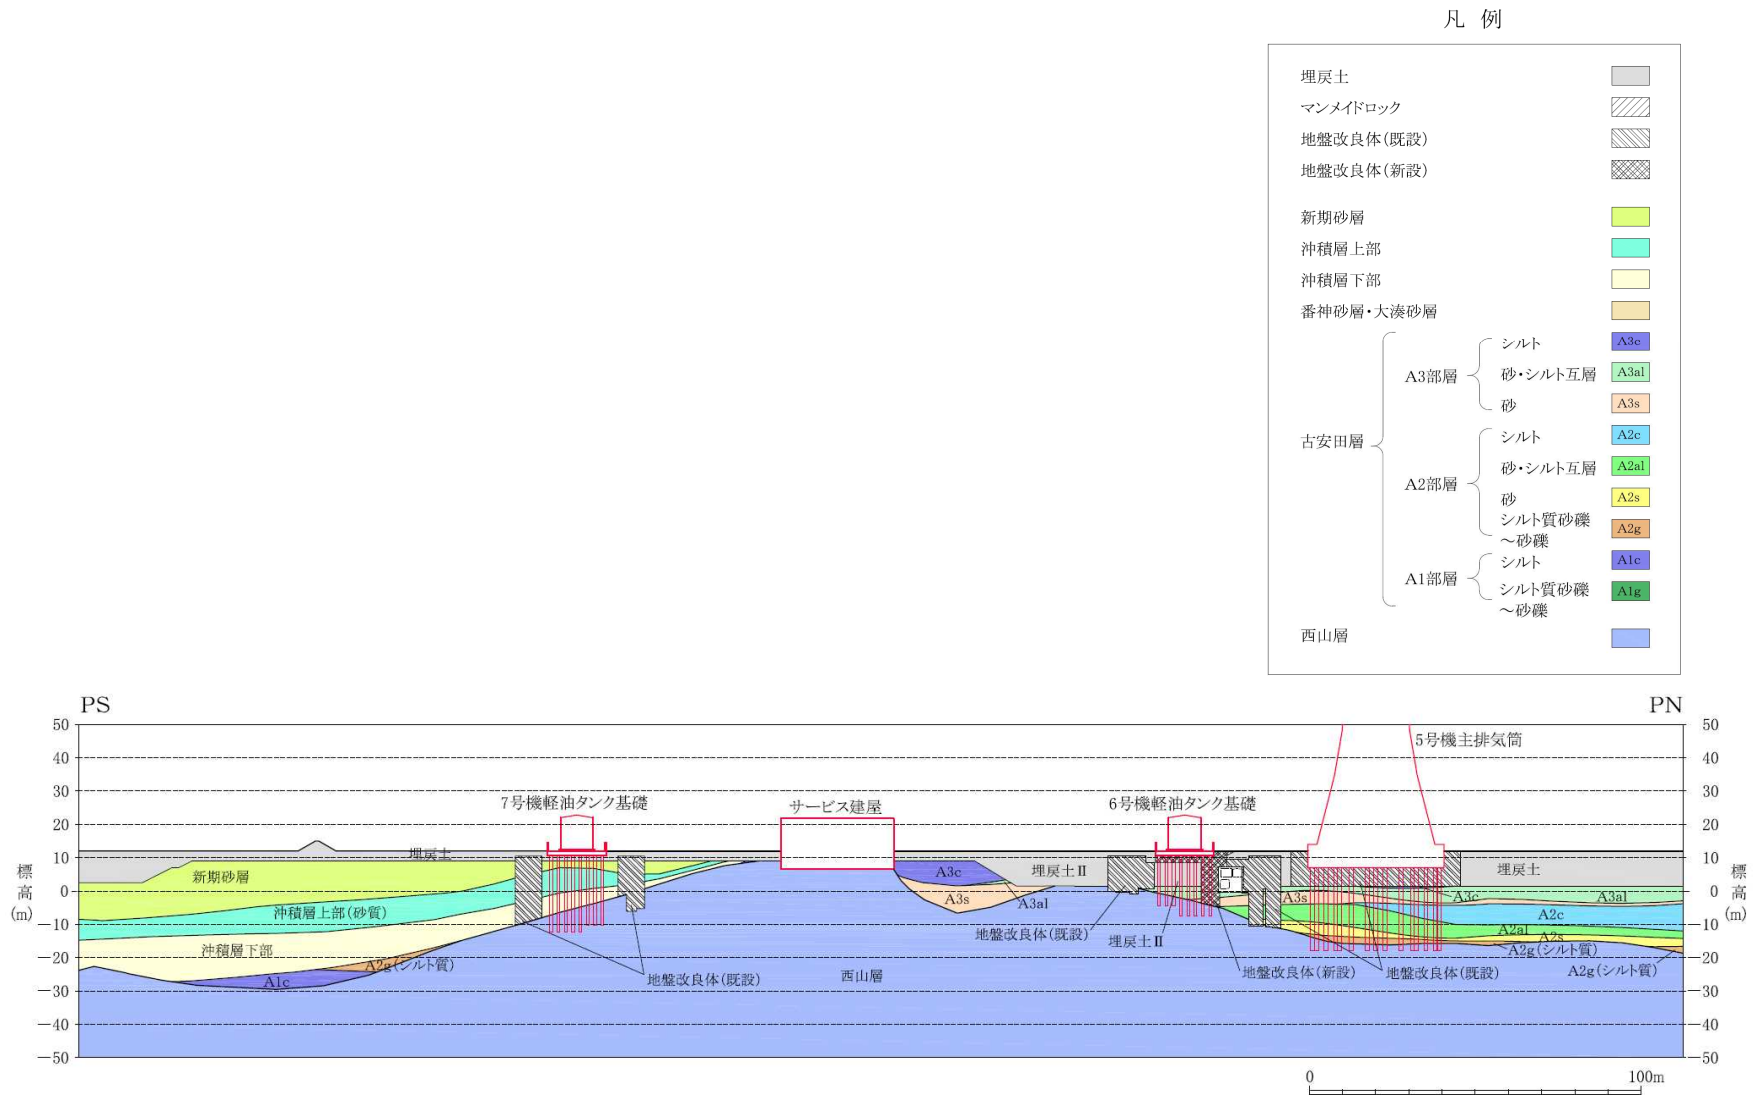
汀線平行 地質断面図 (軽油タンク基礎中央) (E-E断面)
